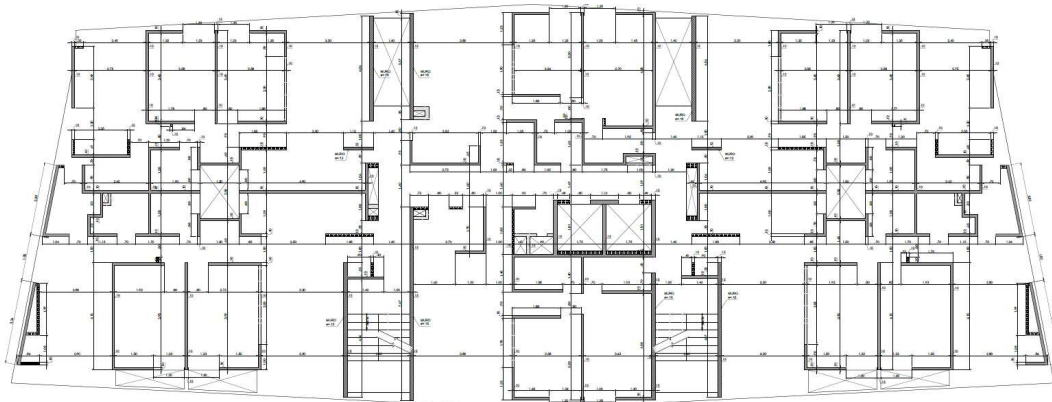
Planta Estructural Pisos 13 a 16, muros $e=.10$ m. Fuente: Elaboración propia.
